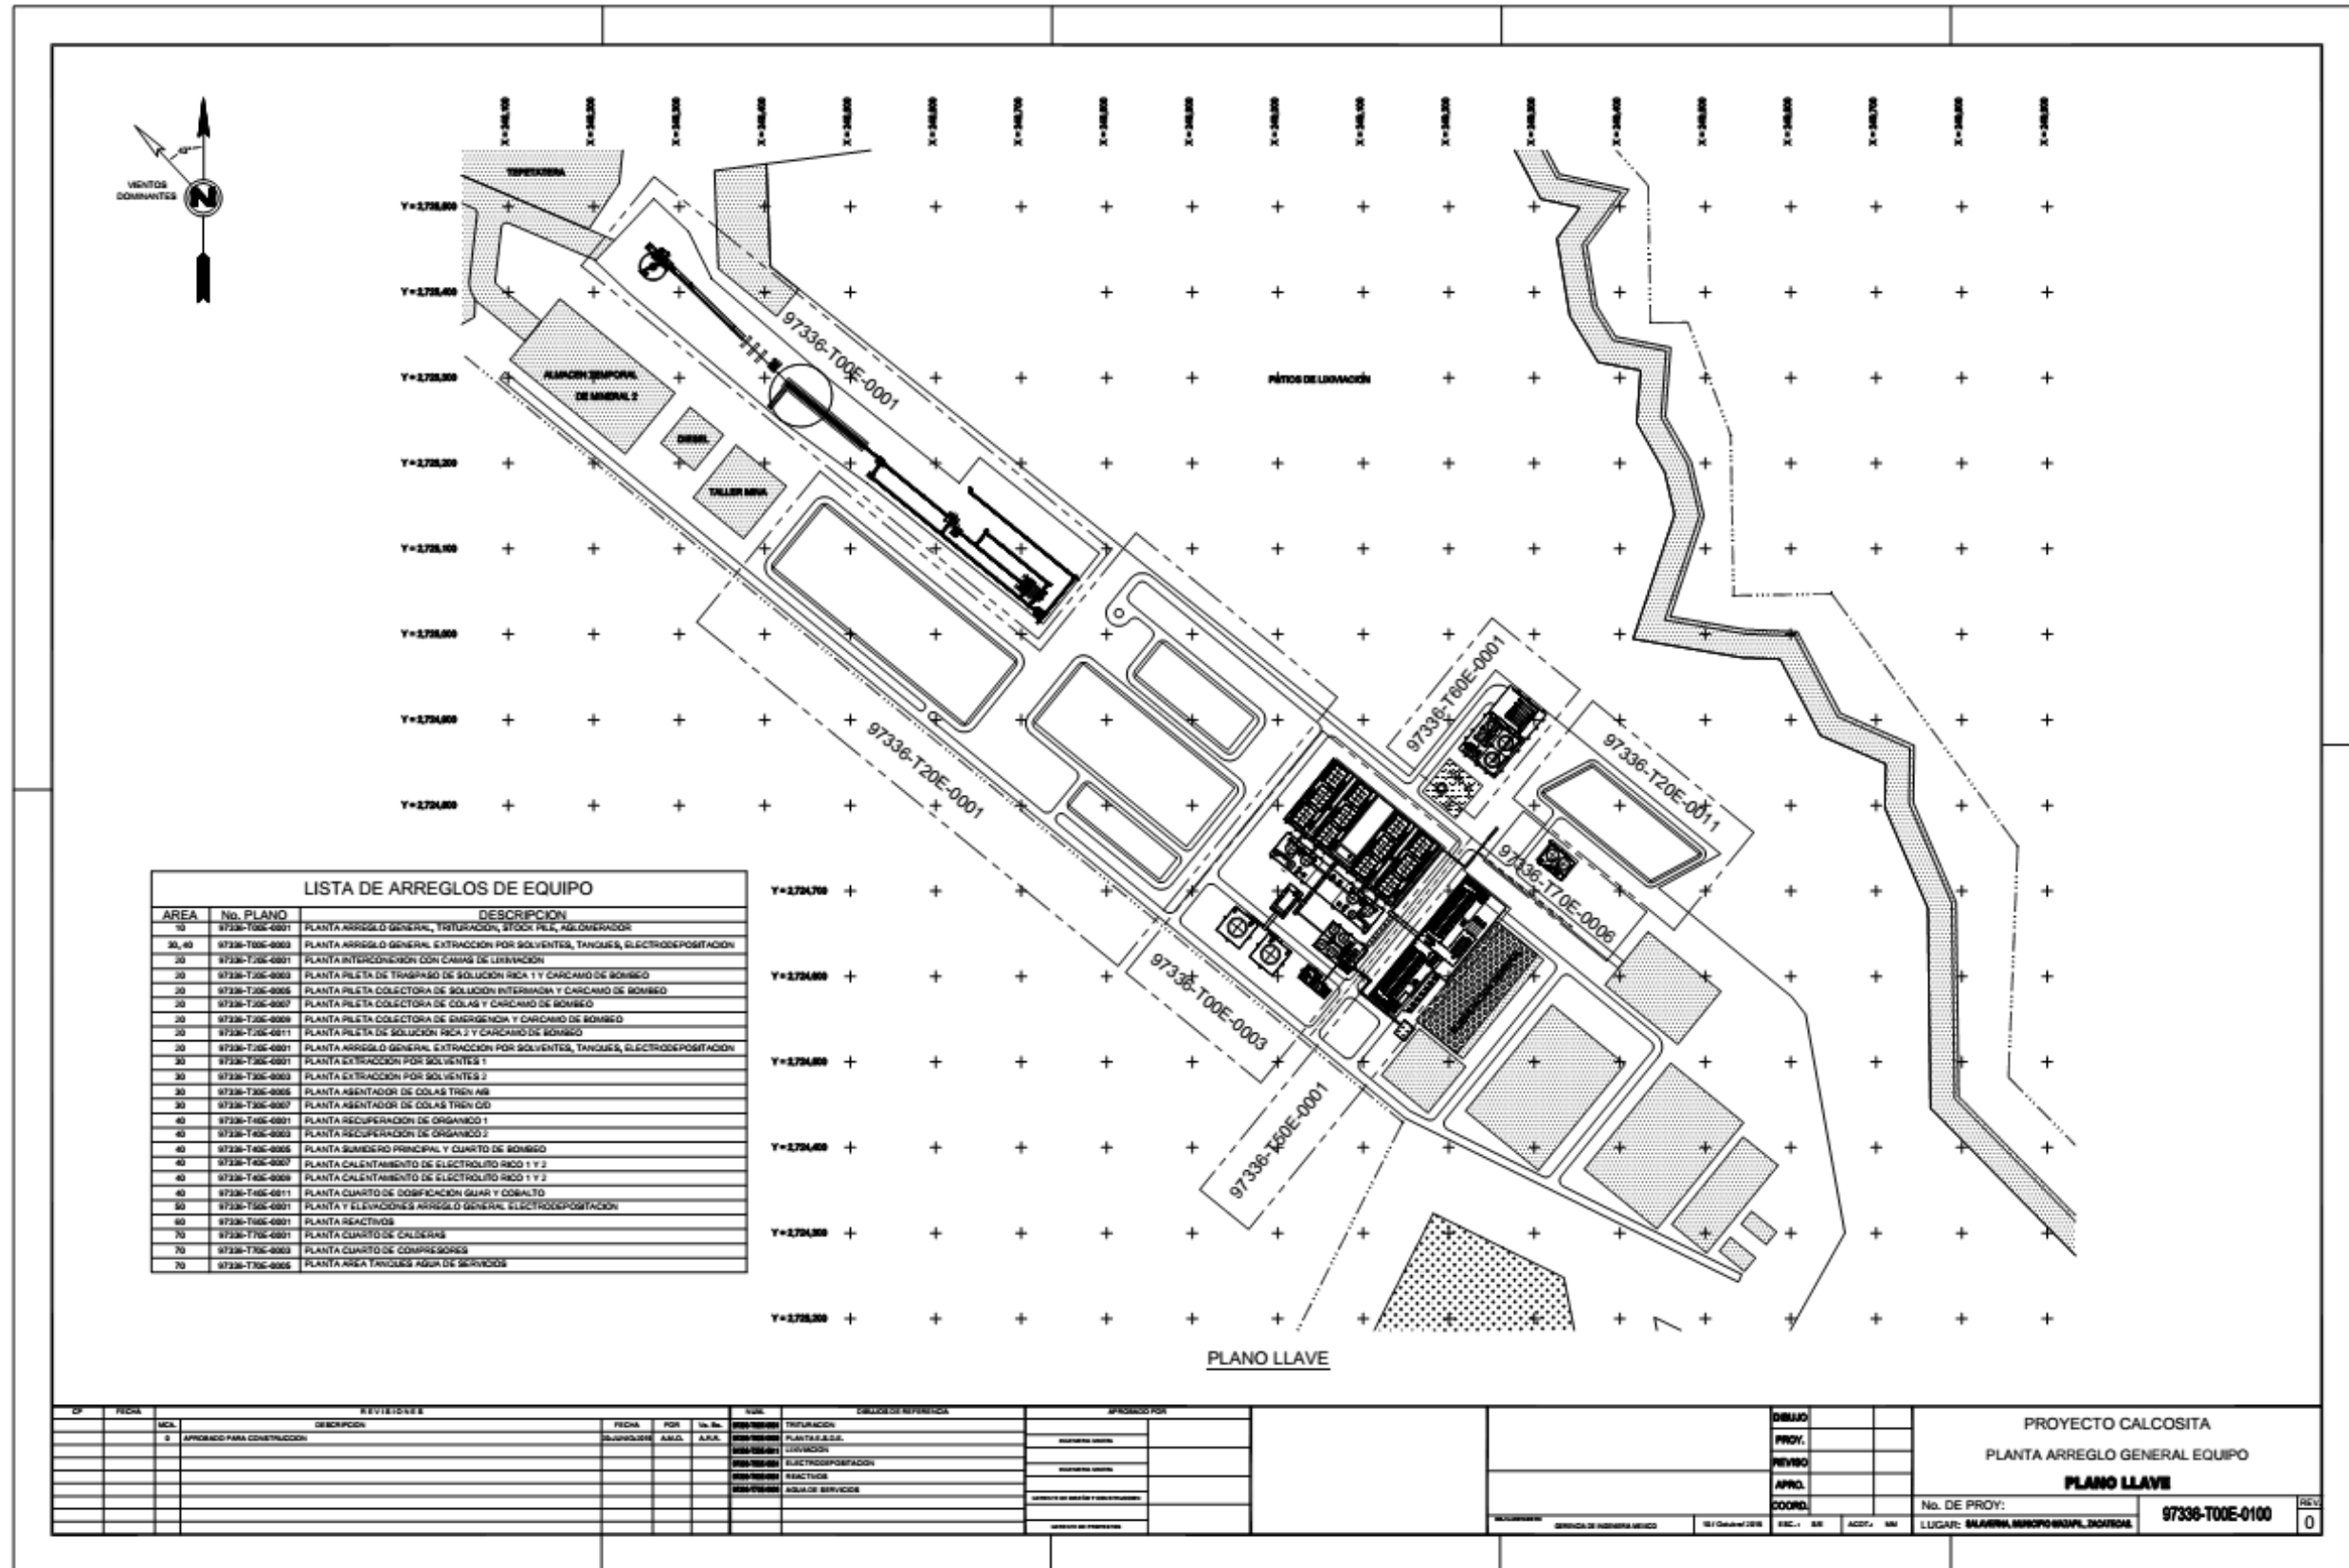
Plano arreglo general de equipo. Fuente Elaboración propia 2014
